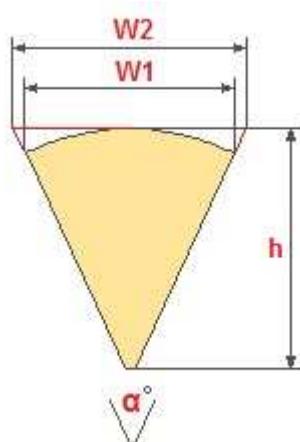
Размеры ступеней винтовой лестницы: h – длина ступени, W_1 – ширина ступени в широкой части, W_2 – ширина заготовки ступени, α – расчетный угол ступени
